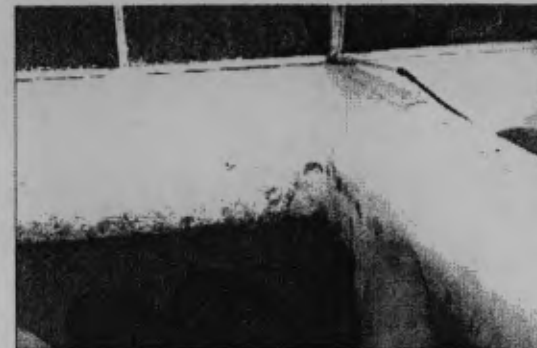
VISTA PLANTA BIOGAS Y RECOLECTOR DE CERDAZA
